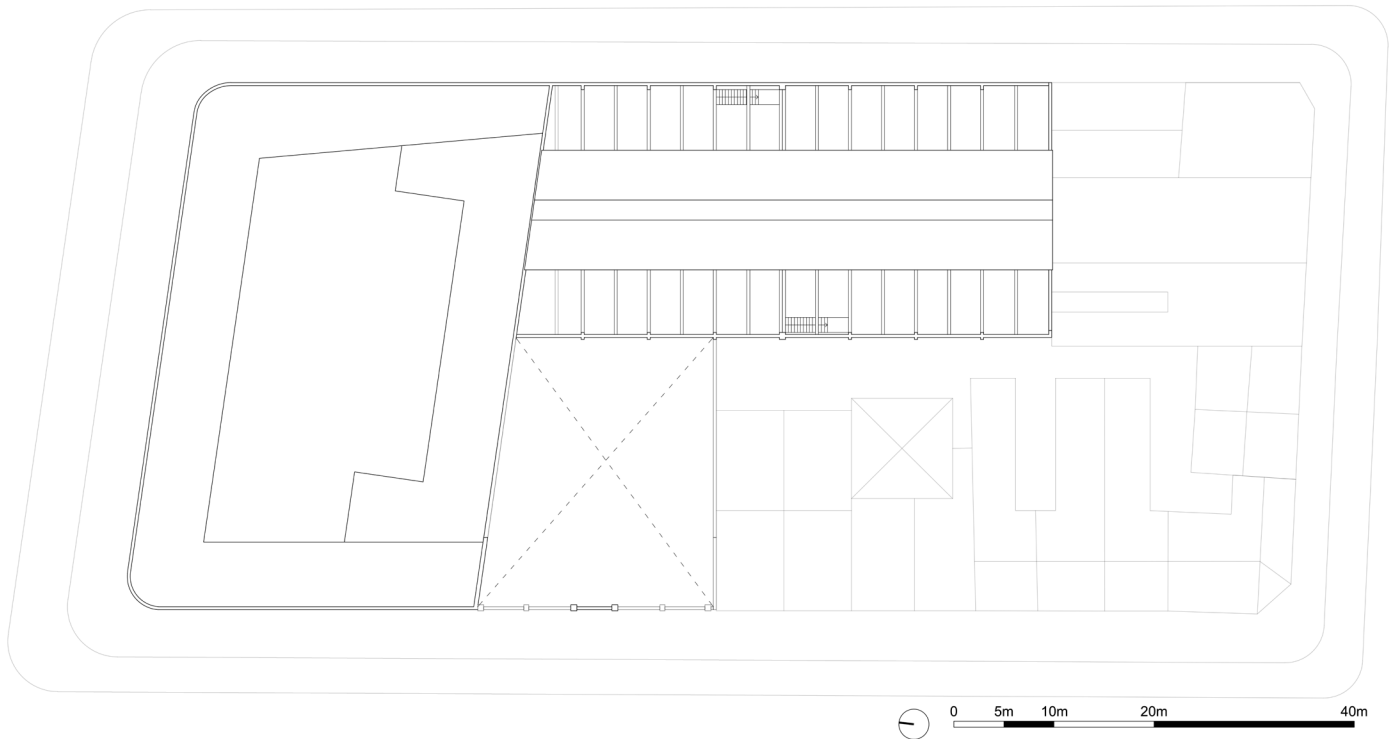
Planta Nivel Cubierta Ex Fundición Metalco. Fuente: elaboración propia.
